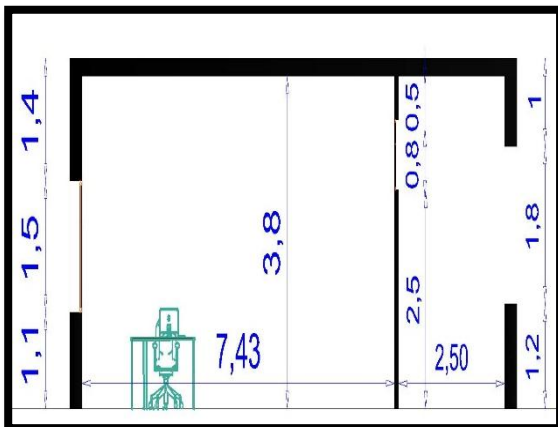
coupe longitudinale sur le bureau choisi. Auteur
